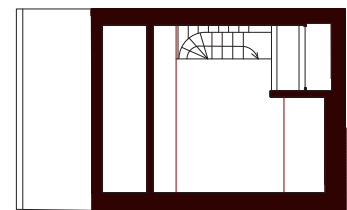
Planta superior tipo B Ilha da Bela Vista - LAHBSocial
